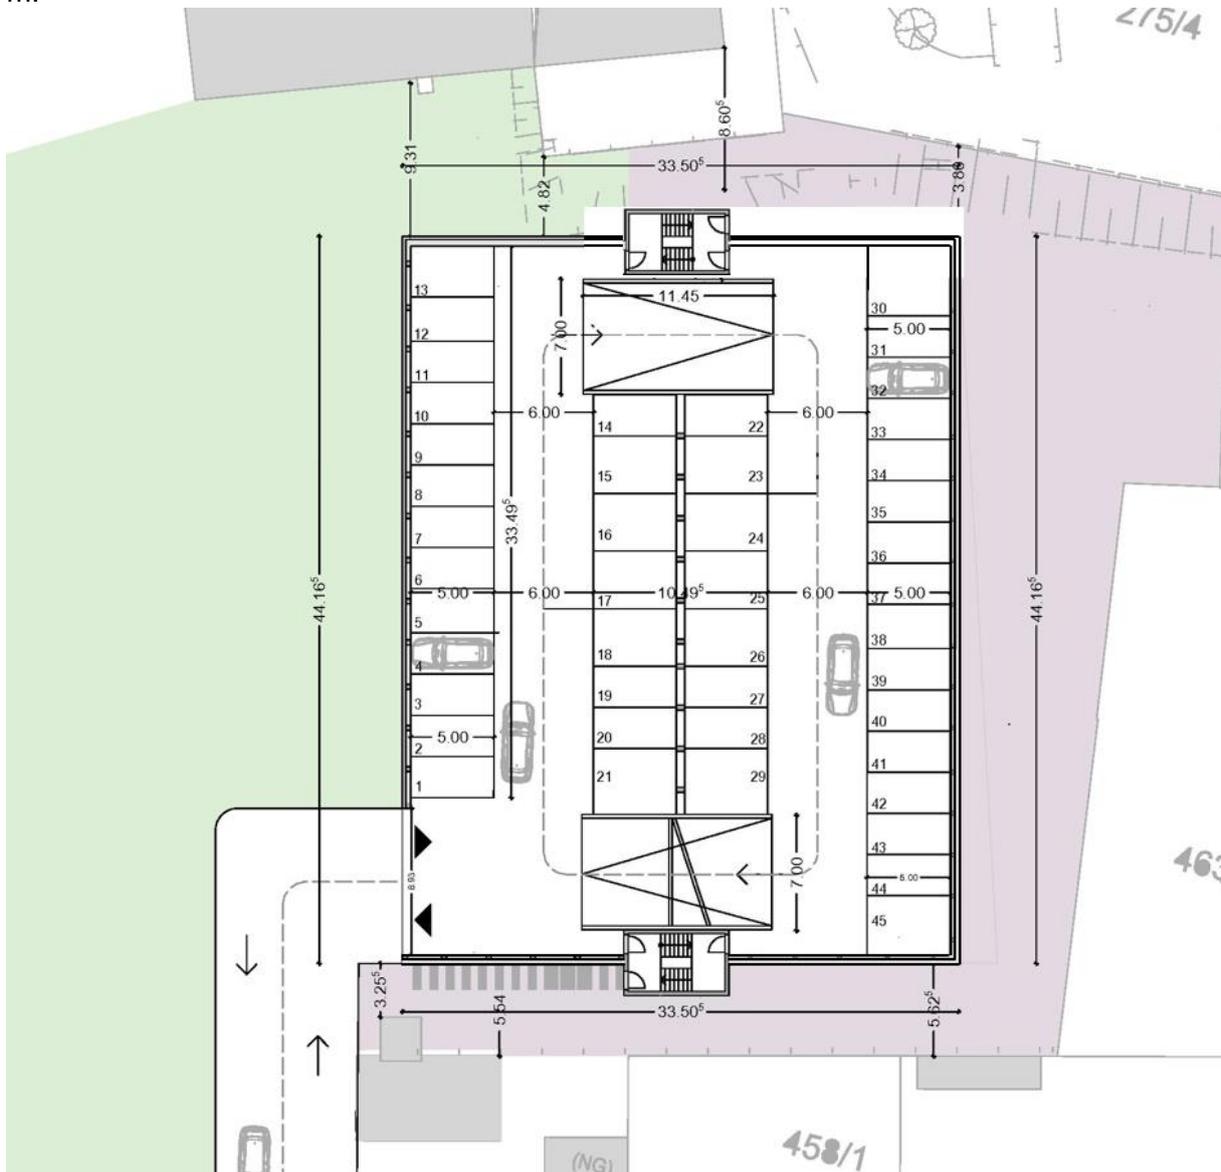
Grundriss Erdgeschoss Parkhaus (GBO)
